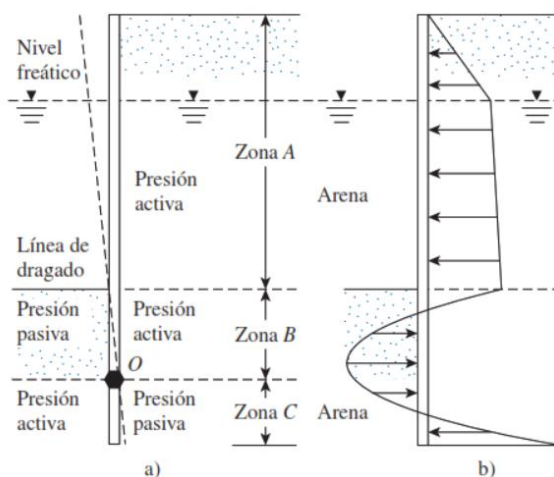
Presiones en tablestacado en voladizo. Tomada de «Fundamentos de ingeniería de cimentaciones», por Braja, 2011, p. 443.
